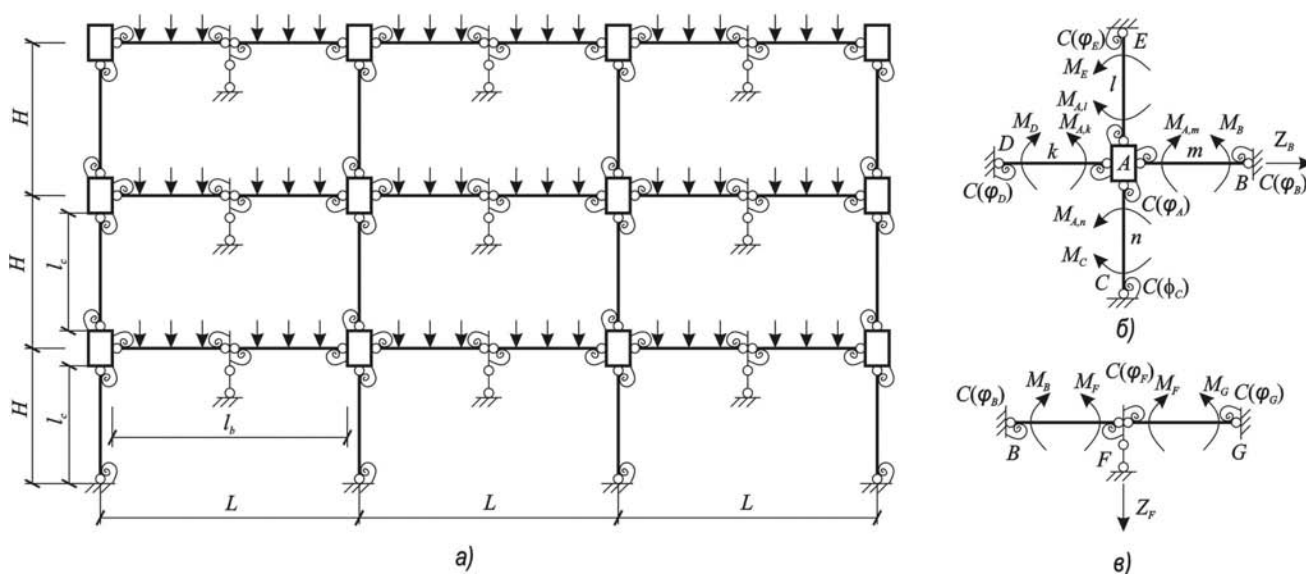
Расчётная схема неординарного смешанного метода для расчёта устойчивости железобетонных каркасов зданий при структурных перестройках, вызванных особым воздействием: а) общий вид схемы; б) схема узла сопряжения колонн и ригелей; в) схема для произвольного нормального сечения по длине ригеля
